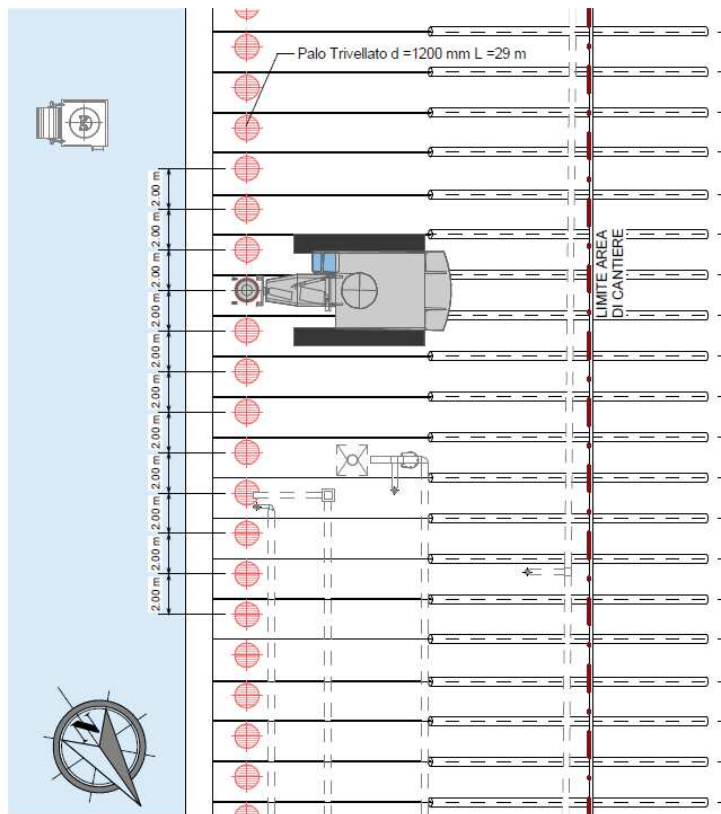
Planimetria con indicazione della posizione dei pali di progetto
